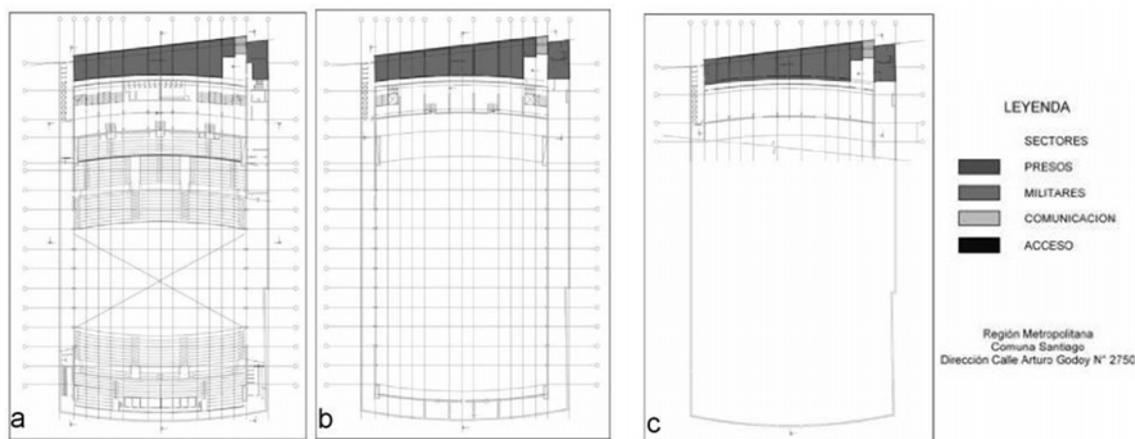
Plano división sectores campo de detención y tortura. a: Piso 3. b: Piso 4. c: Piso 5.
